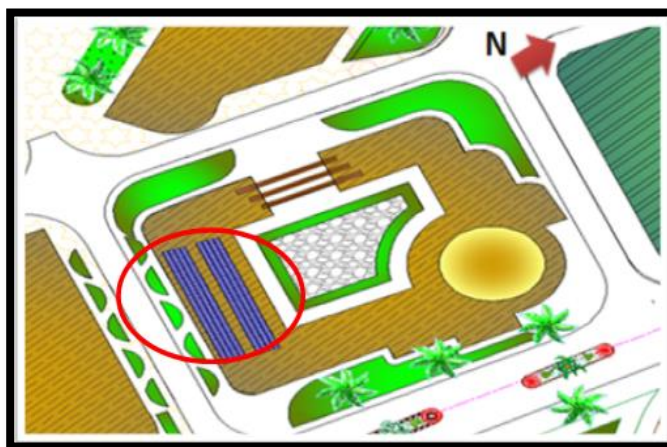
plan 2D l'Intégration des panneaux photovoltaïque au toit d'équipement /Source : par auteur
